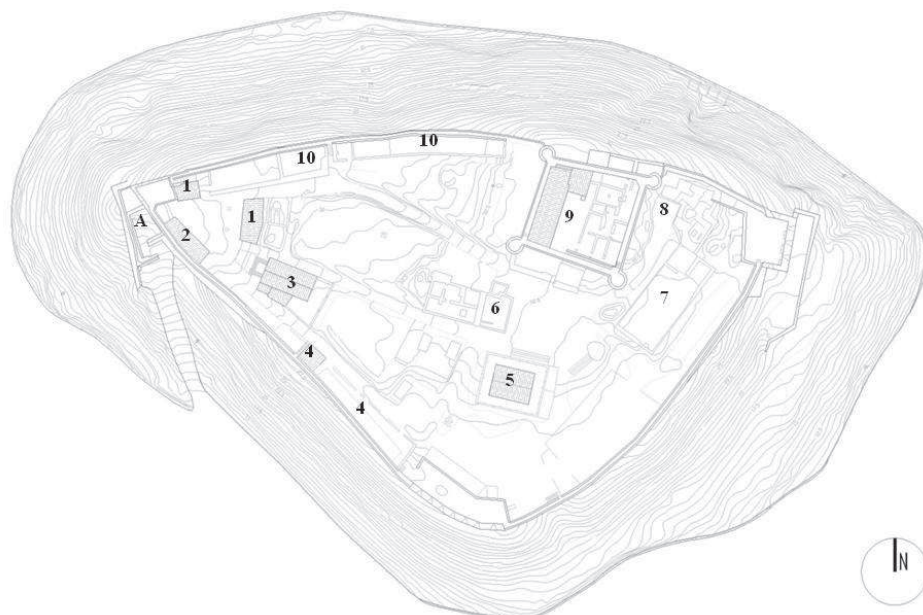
Planta do Castelo de Castro Marim, indicado a localização das novas funções. [Planta trabalhada sobre base cedida pela CMCM]
